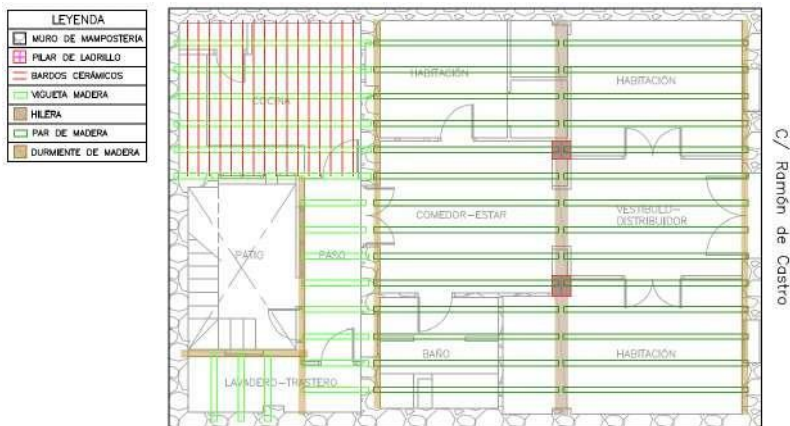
Análisis estructural de la vivienda existente. Fuente propia
